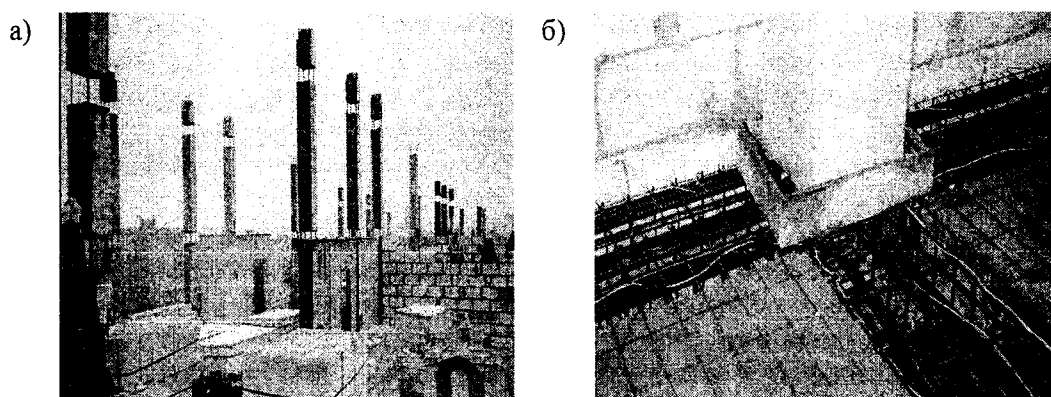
Варианты армирования диска перекрытия сборно-монолитного каркаса жилого дома в г. Орле: а - общий вид каркаса; б - узел сопряжения монолитных ригелей с колонной
